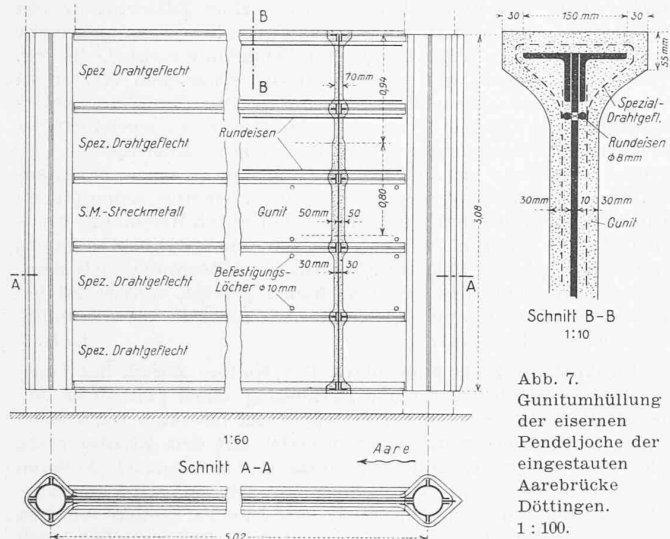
Gunitumhüllung der eisernen Pendeljoche der eingestauten Aarebrücke Döttingen. 1:100.
